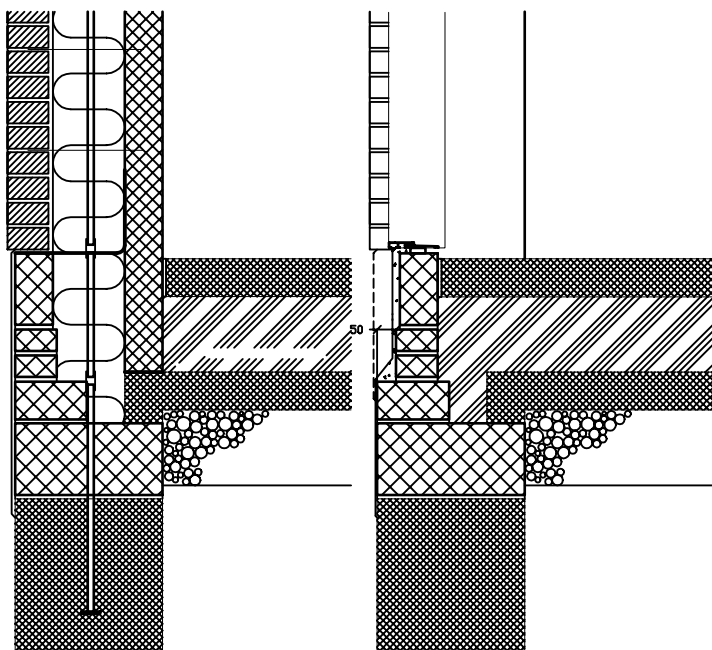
Hus E. Skalmurede porebetonelementer. Facader.
